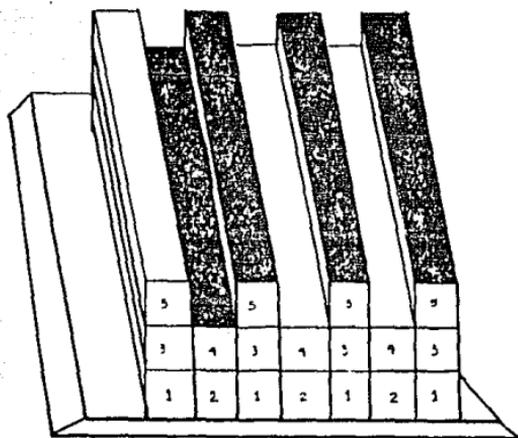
SECUCENCIA DEL COLADO DE PILES
